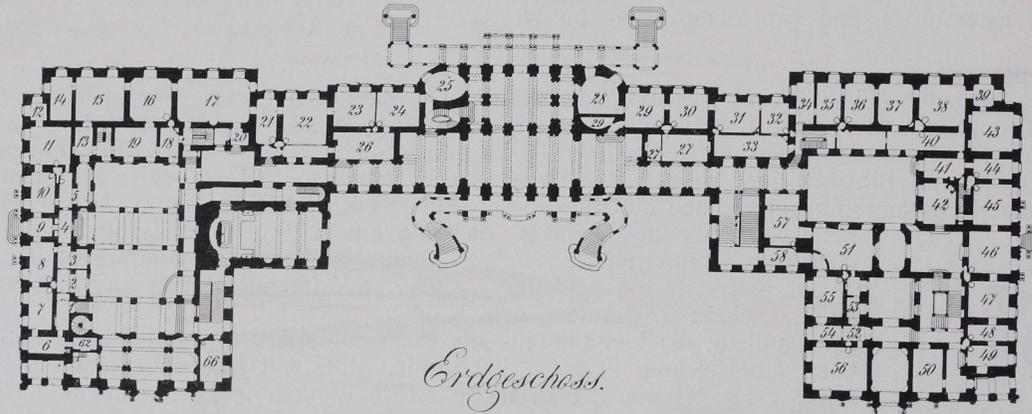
Schönbrunn, Grundriß des Erdgeschosses (S. 118)
